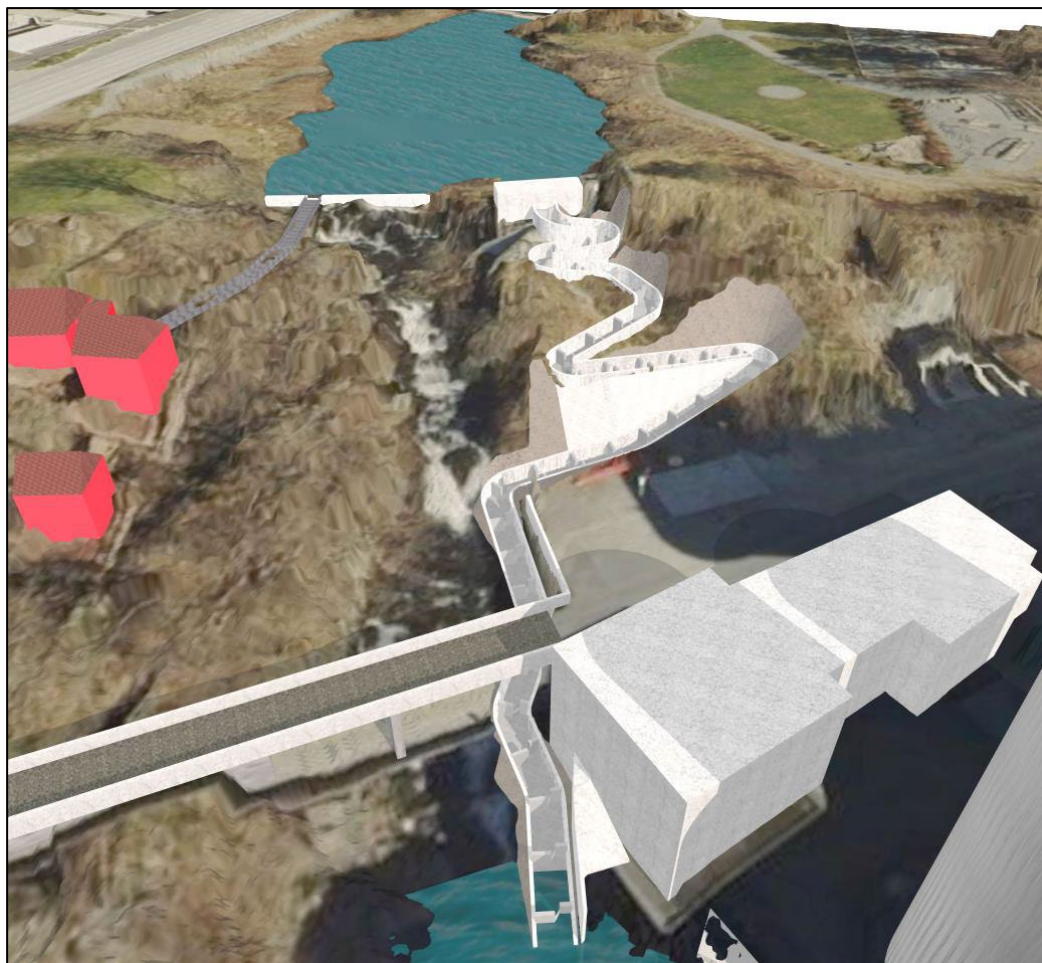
påhugg tunnel, utsnitt fra 3D modell
